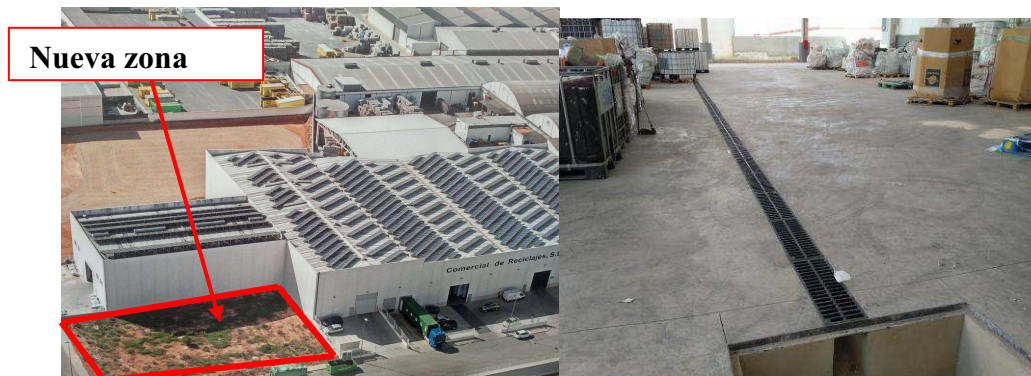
Y 2: Vista general de la zona verificada y vista cercana del pavimento.
